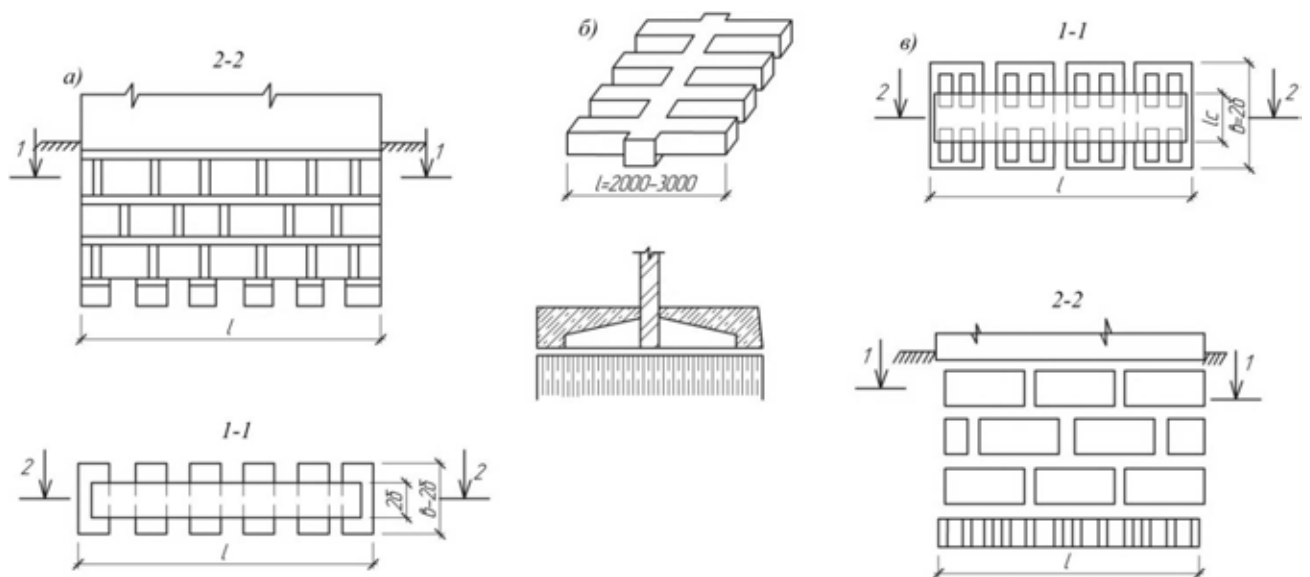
Деякі види переривчастих фундаментів: а - стрічковий переривчастий фундамент; б – переривчасто-шпальний фундамент; в – переривчасто-решітчастий фундамент.
